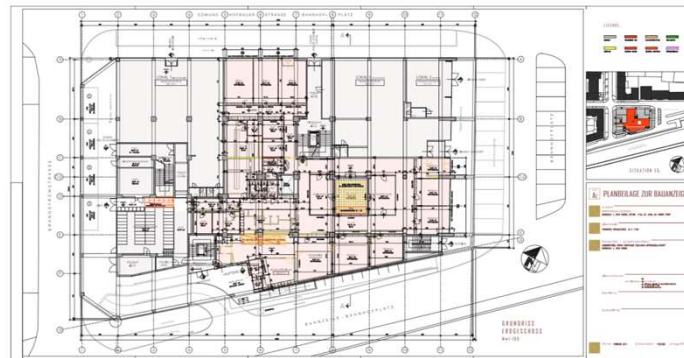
Grundriss EG GEDESAG Centrale (© GEDESAG)
